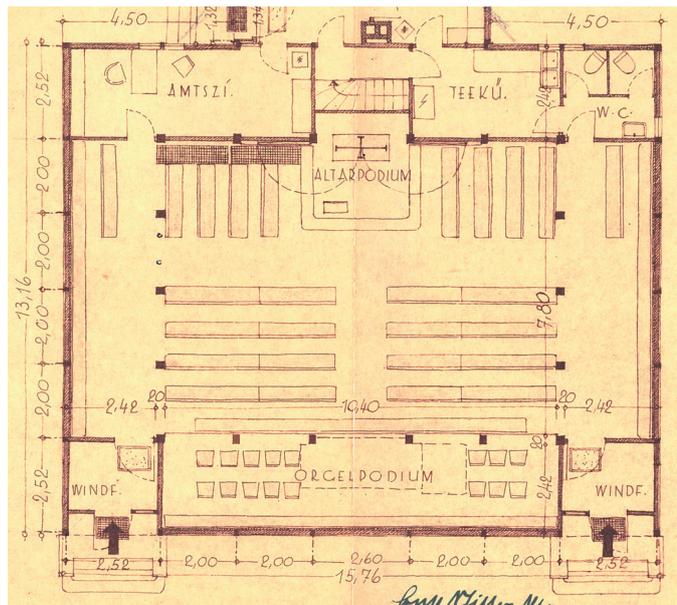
Grundriss Friedenskirche Neufahrn, Nutzung als Kirchenraum, Otto Bartning, Januar 1949, M ca. 1:200
